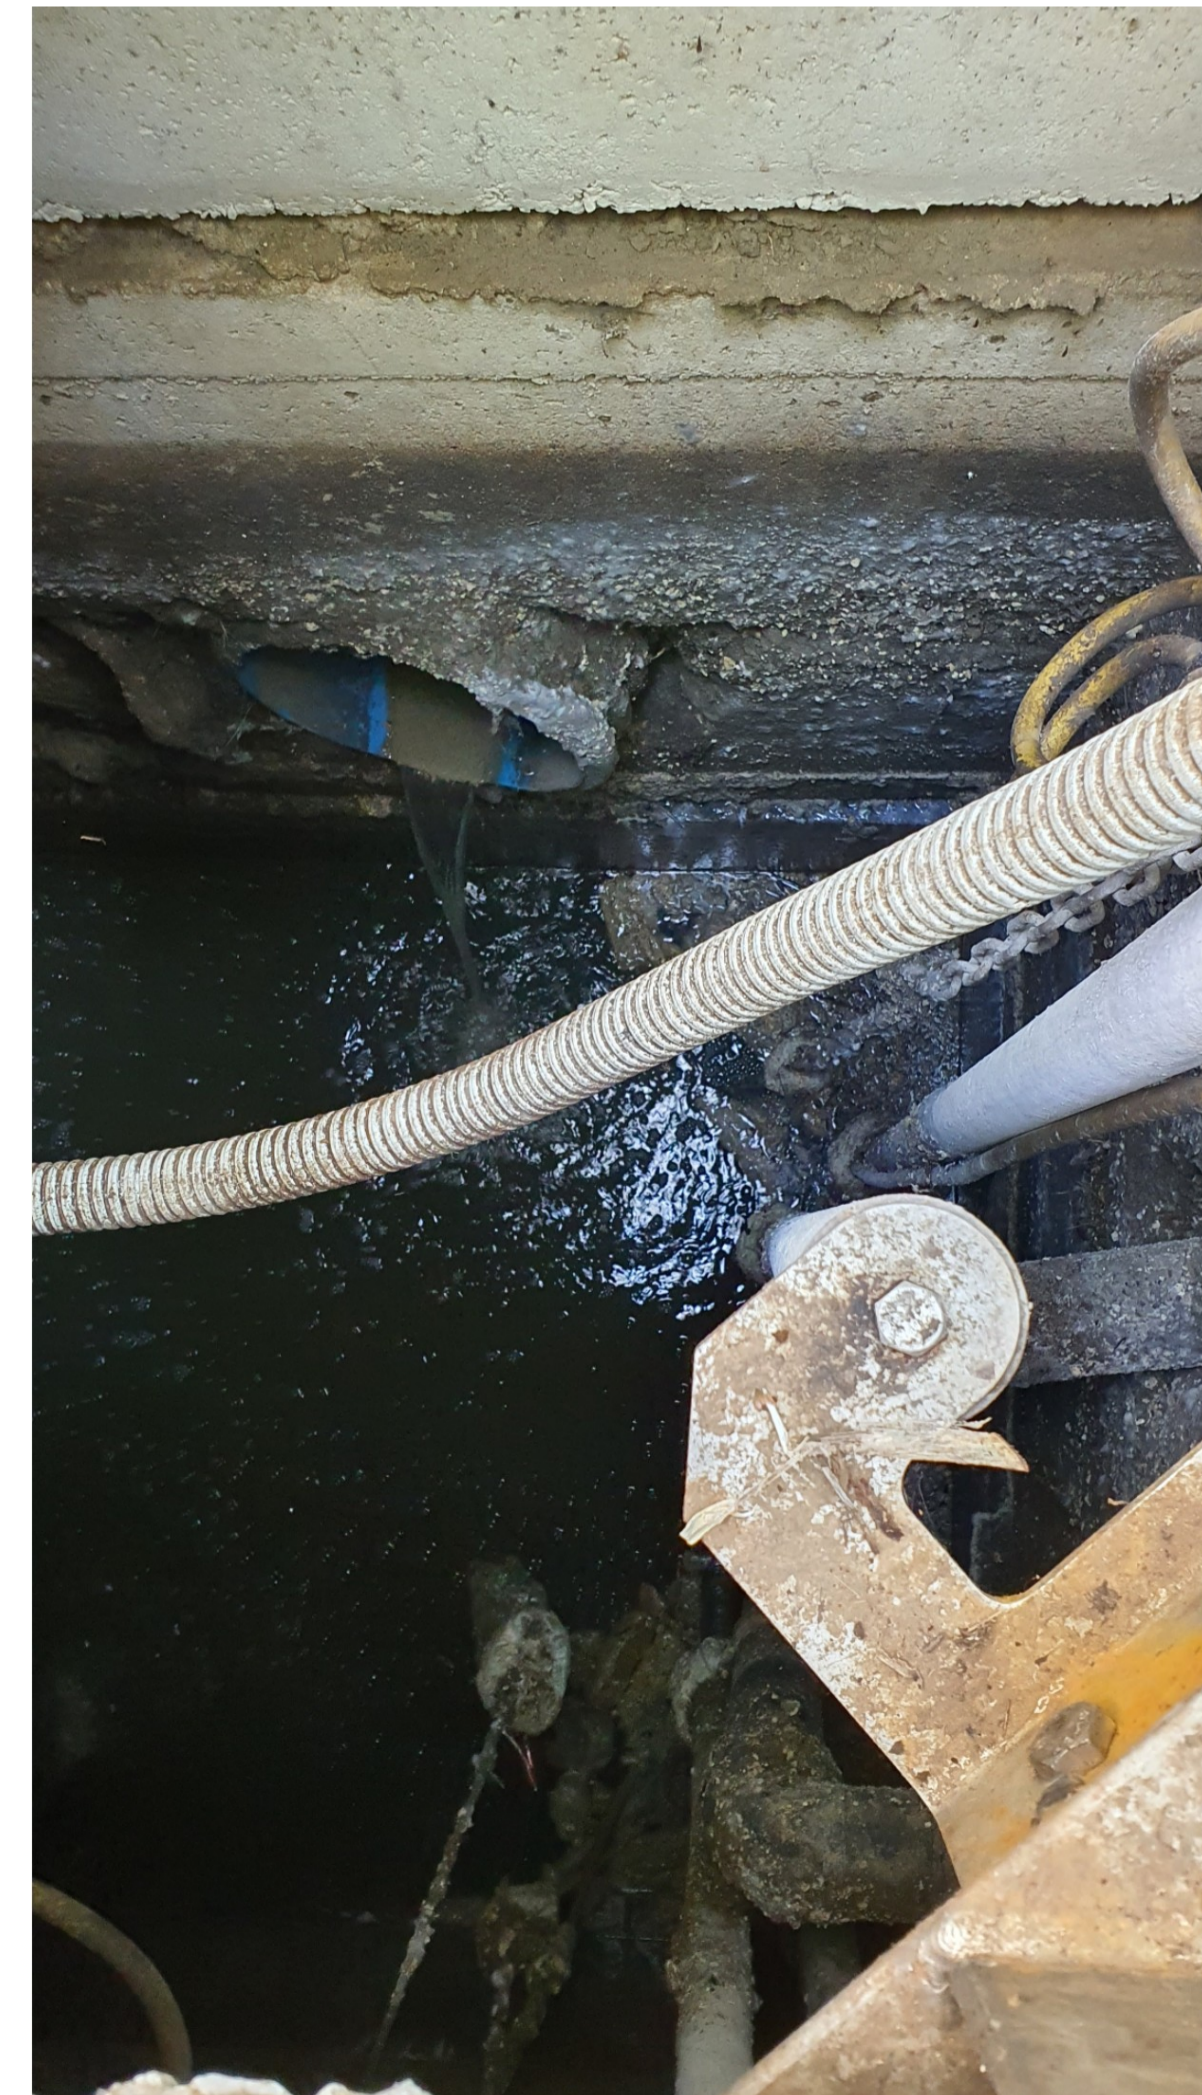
Condotte in ingresso al pozzetto di sollevamento
